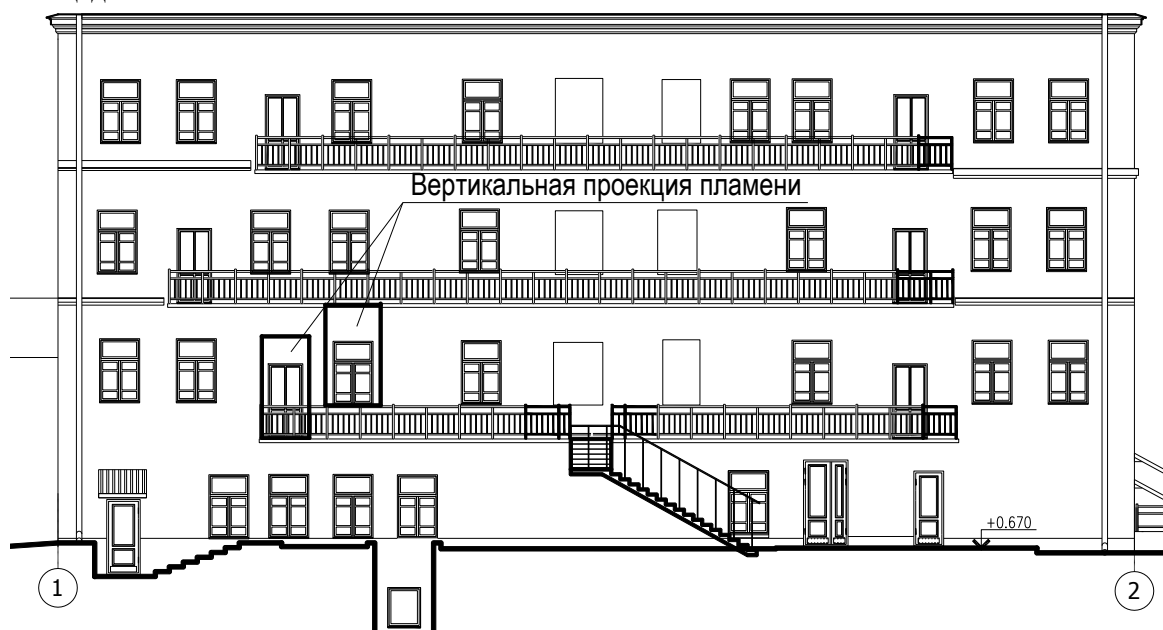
Вертикальная проекция пламени на фасаде здания
